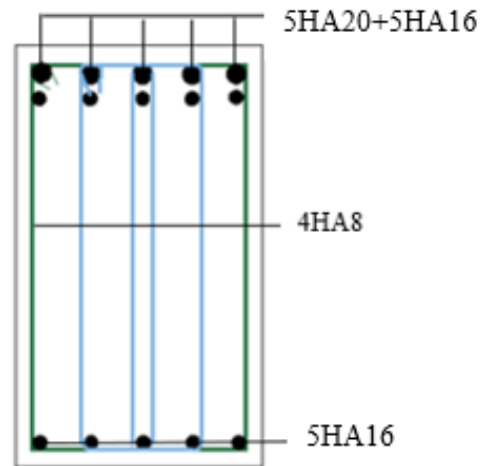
Coupe de ferrailage des poutres principales au niveau d'appuis
